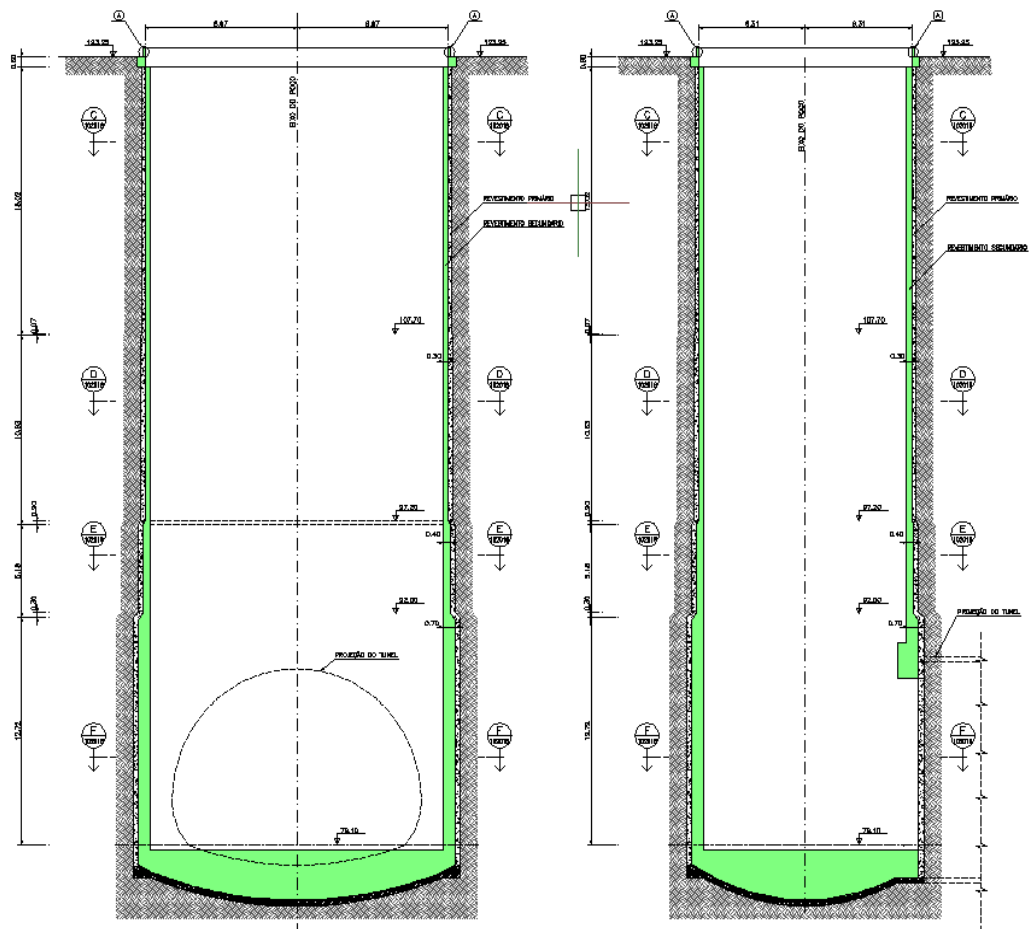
Cortes pelo maior e menor diâmetro do poço de ventilação (adaptado CIC, 2009).
